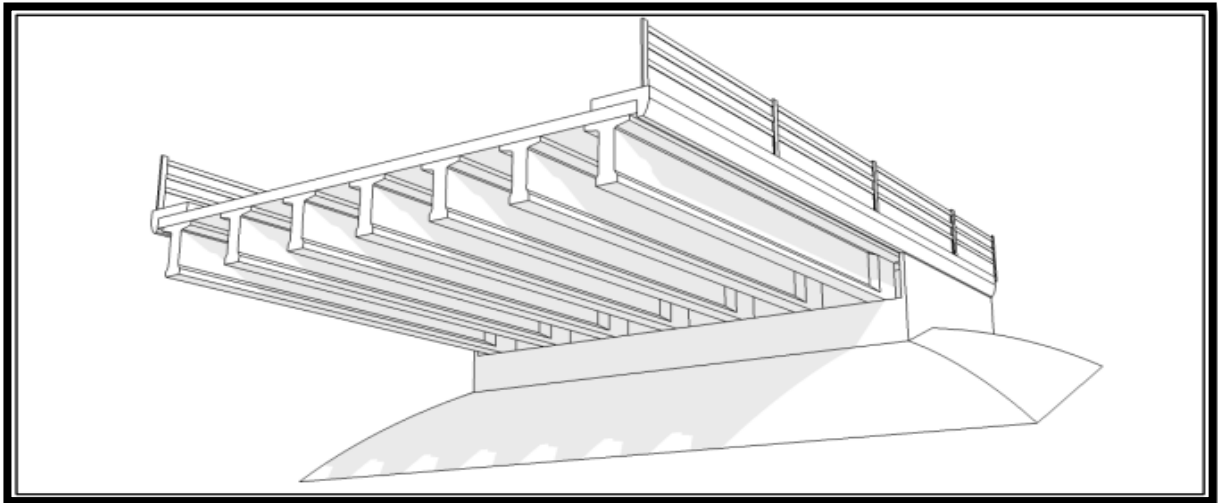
Morphologie générale d'un pont à poutres en béton précontraint
